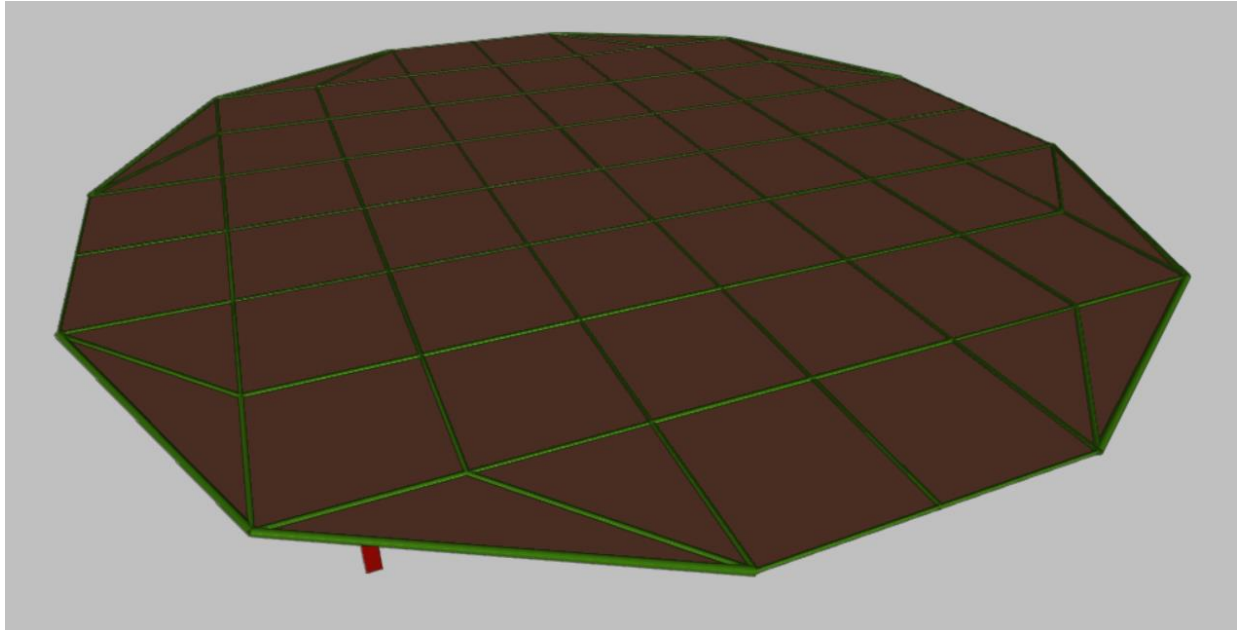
Estructura tras la comprobación y dimensionamiento - vista superior.
